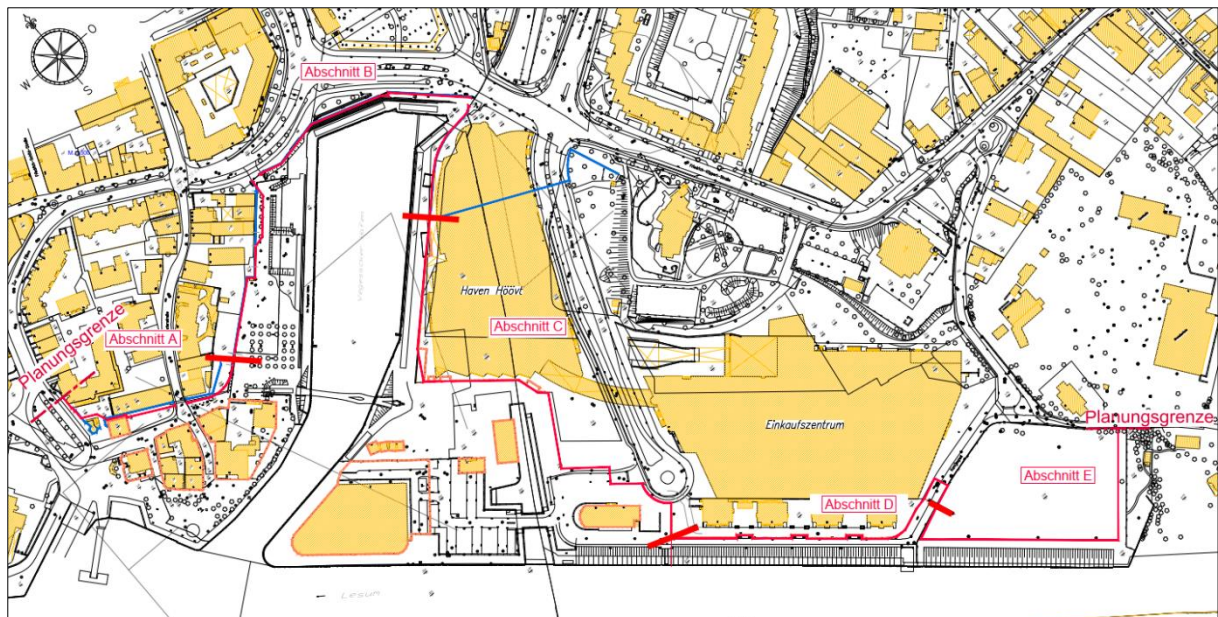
Planungs- und Abschnittsgrenzen des Projektes „Erhöhung der Landesschutzdeichlinie in Bremen Vegesack“ (ursprünglicher Lageplan)
